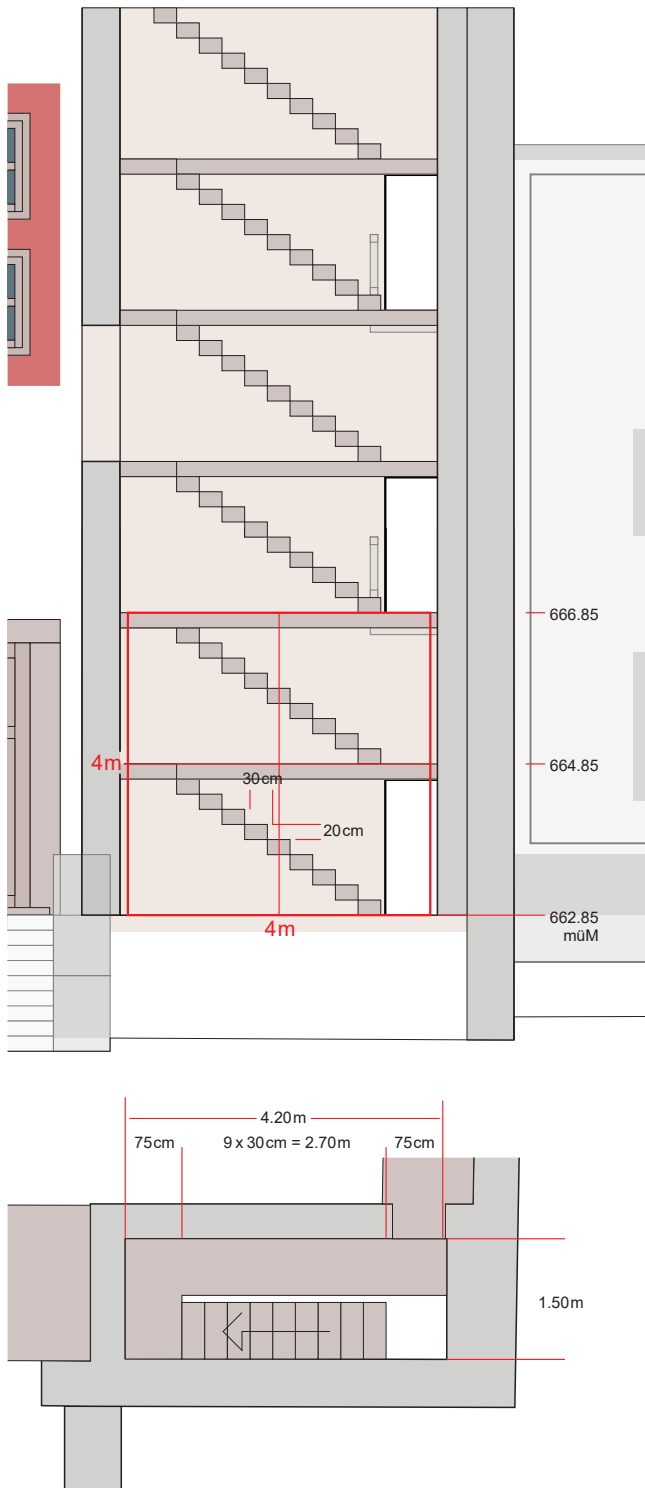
Meikirch. Rekonstruktion der Villa, Phase 2: Hallenhaus mit Annex. Schnitt und Plan des Treppenhauses und Grundmodul der architektonischen Komposition (4 x 4 m, rot). M. 1:100.
